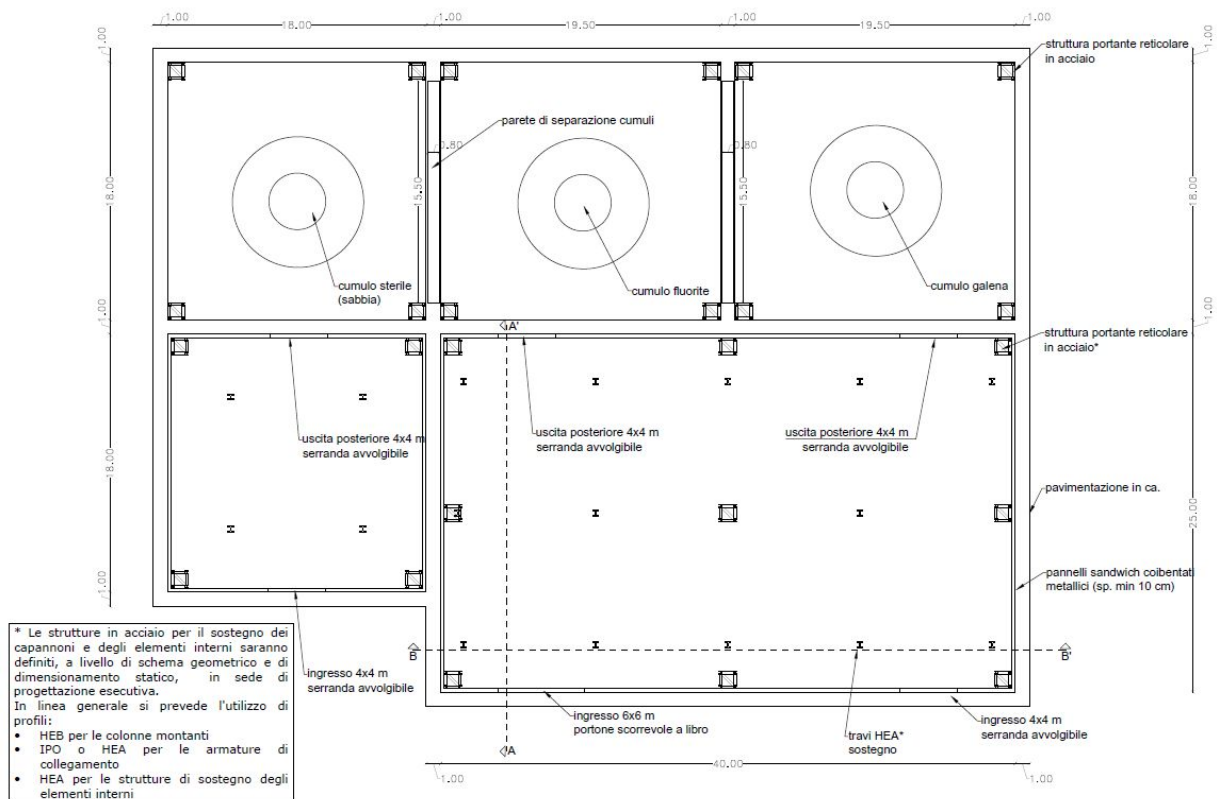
Pianta (non in scala) dell'impianto di flottaggio e delle strutture ad esso connesso.
